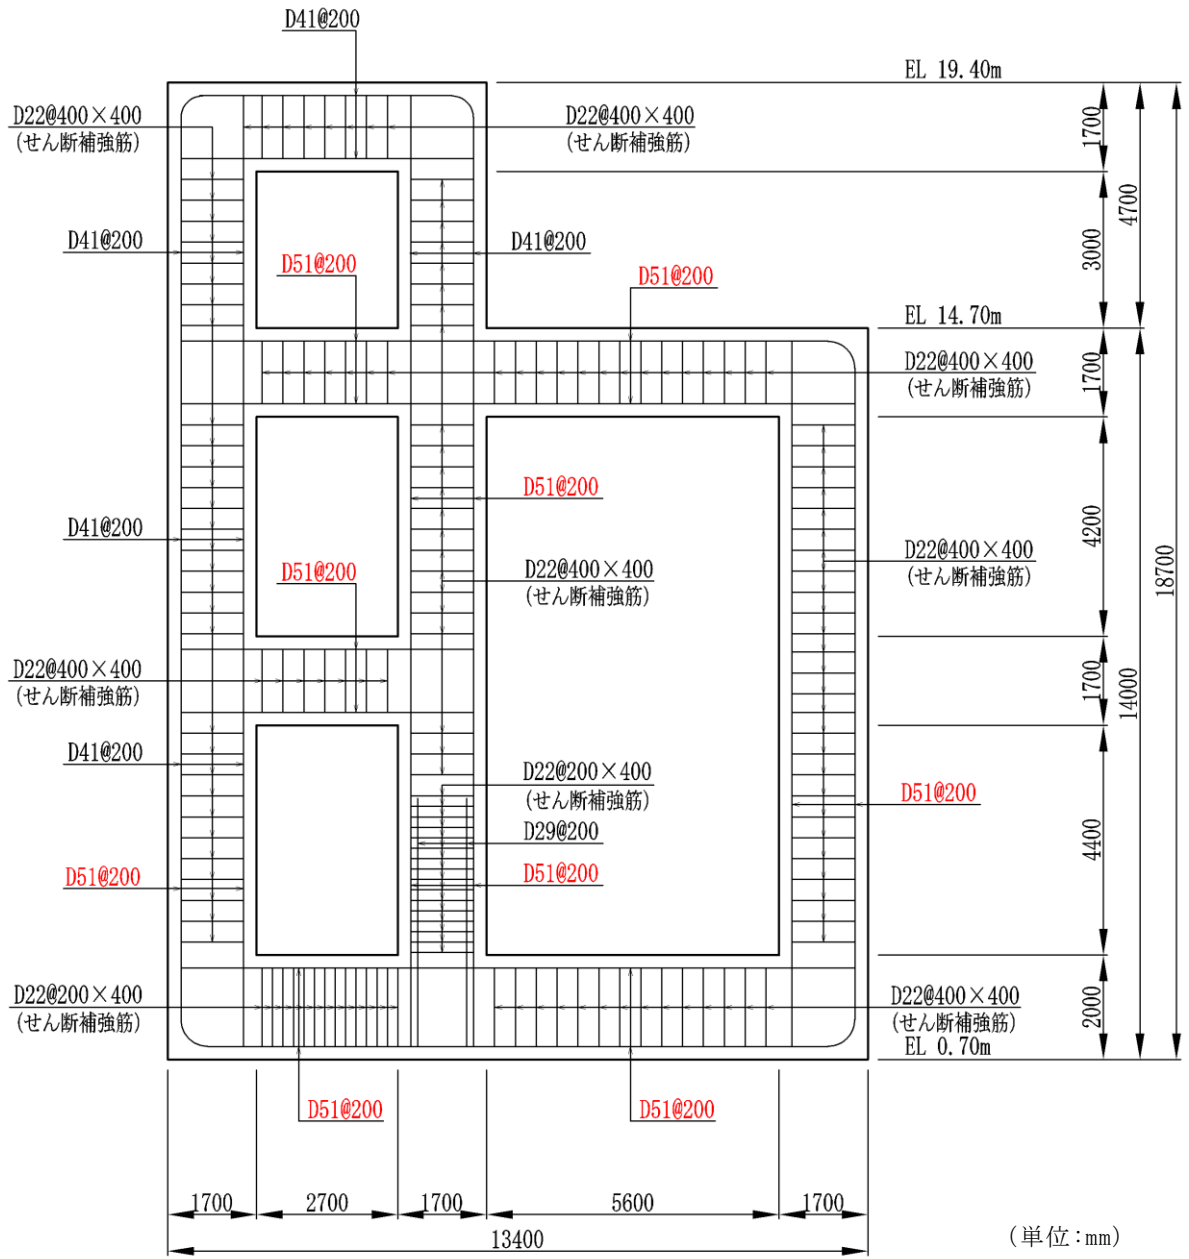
第 1 ベントフィルタ格納槽概略配筋図 (A-A 断面)
